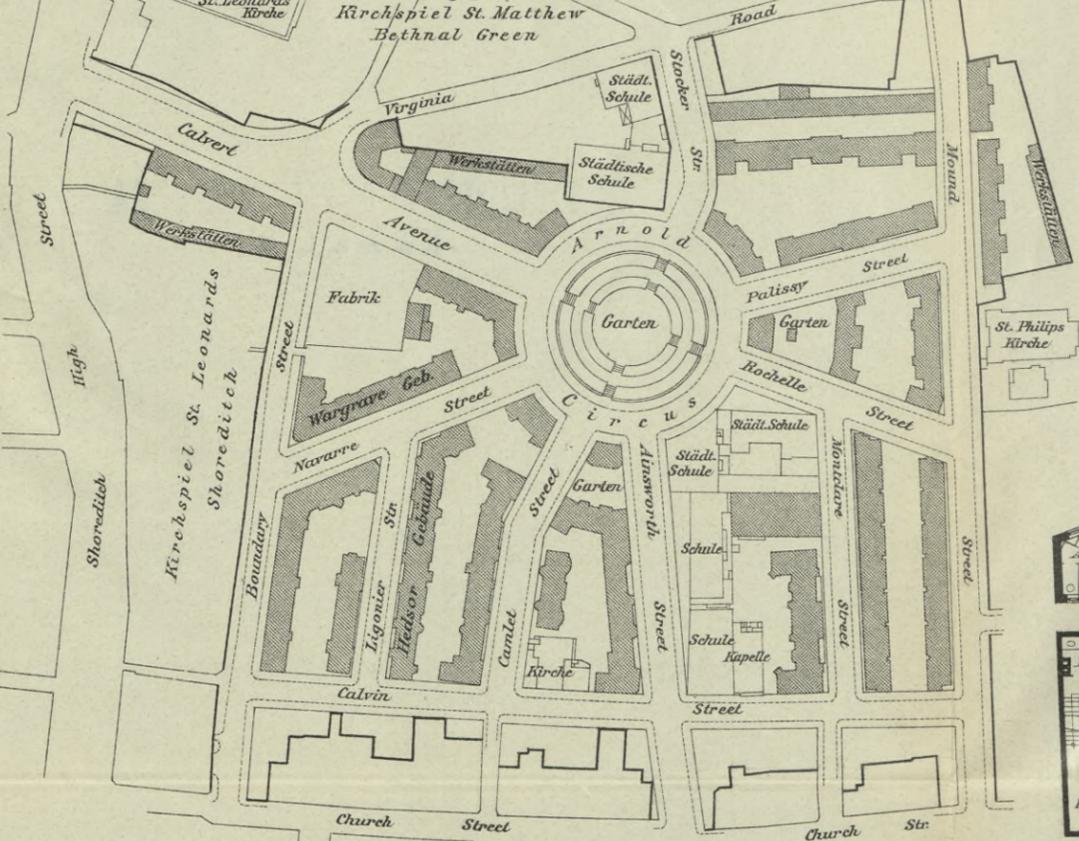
Neuer Bebauungsplan an der Boundary-Street.
